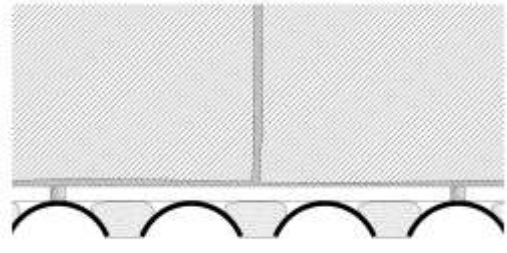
| Detalhamento construtivo de empena revestida em telha cerâmica capa-canal, com a parte côncava da telha orientada para o exterior e as juntas entre as telhas preenchidas com argamassa. (desenho do autor)
